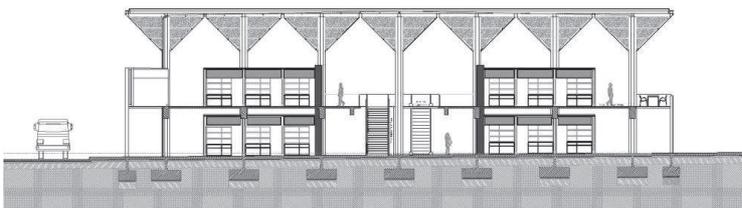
VISTA SECCION TRANSVERSAL
